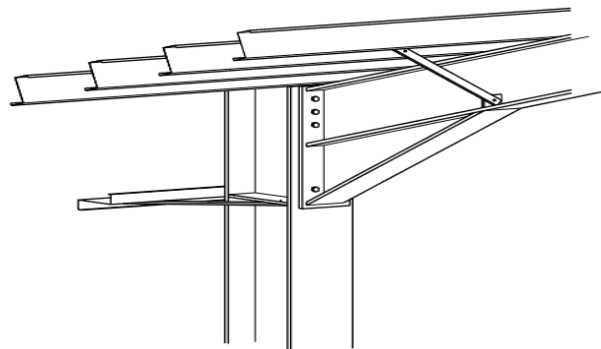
Sistema de “asas de anjo” para travamento do banzo inferior [3].
